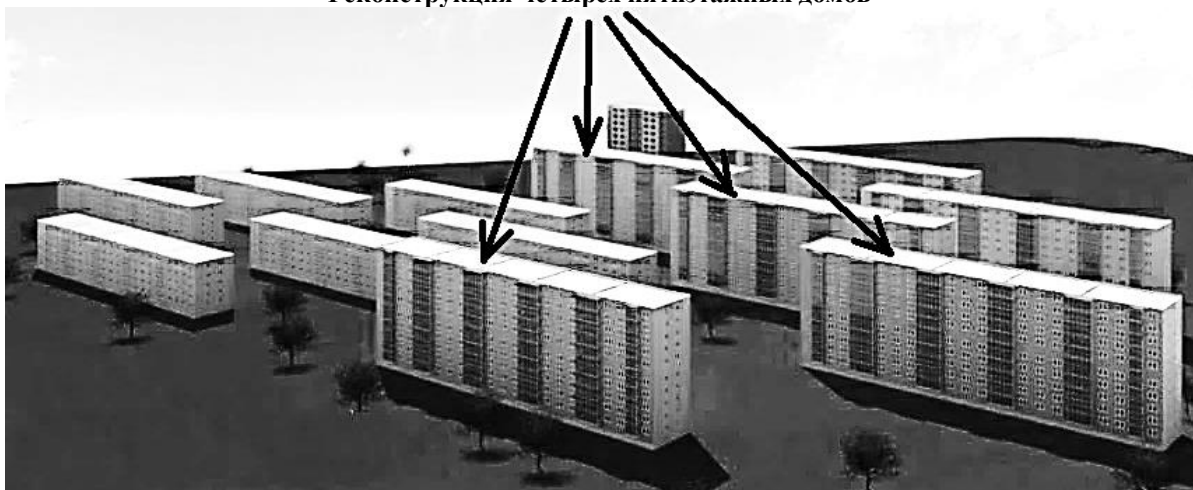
Реконструкция четырех пятиэтажных домов с возведением на их месте четырех десятиэтажных ДВЗ
